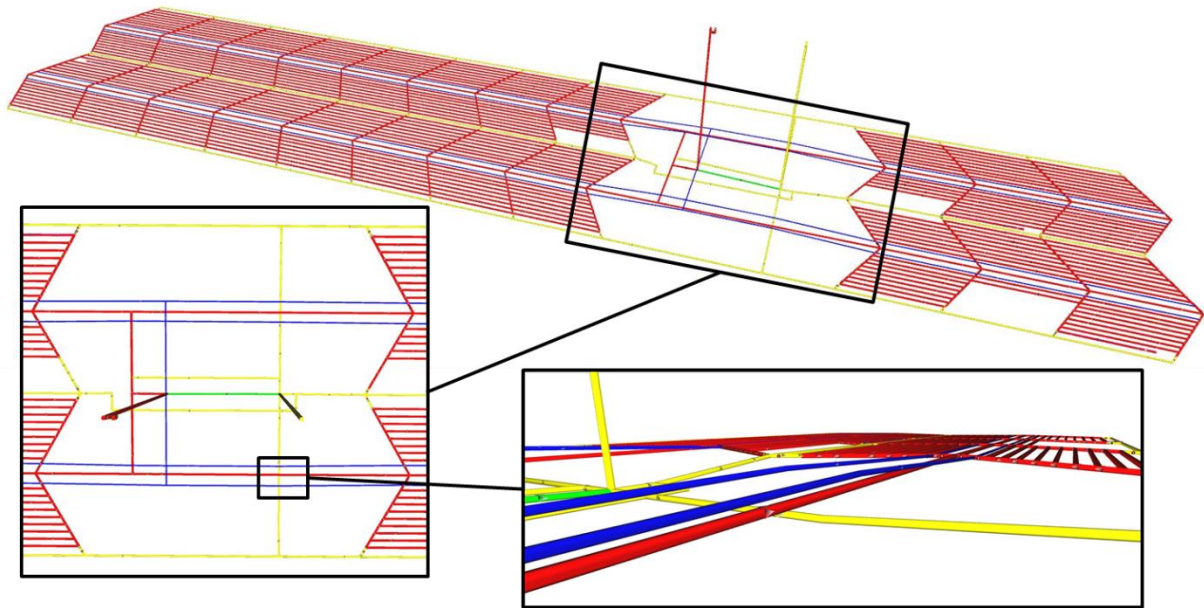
Grubengebäude gesamt mit Draufsicht Zentralbereich und Detailansicht Überführung der Hauptstrecken
